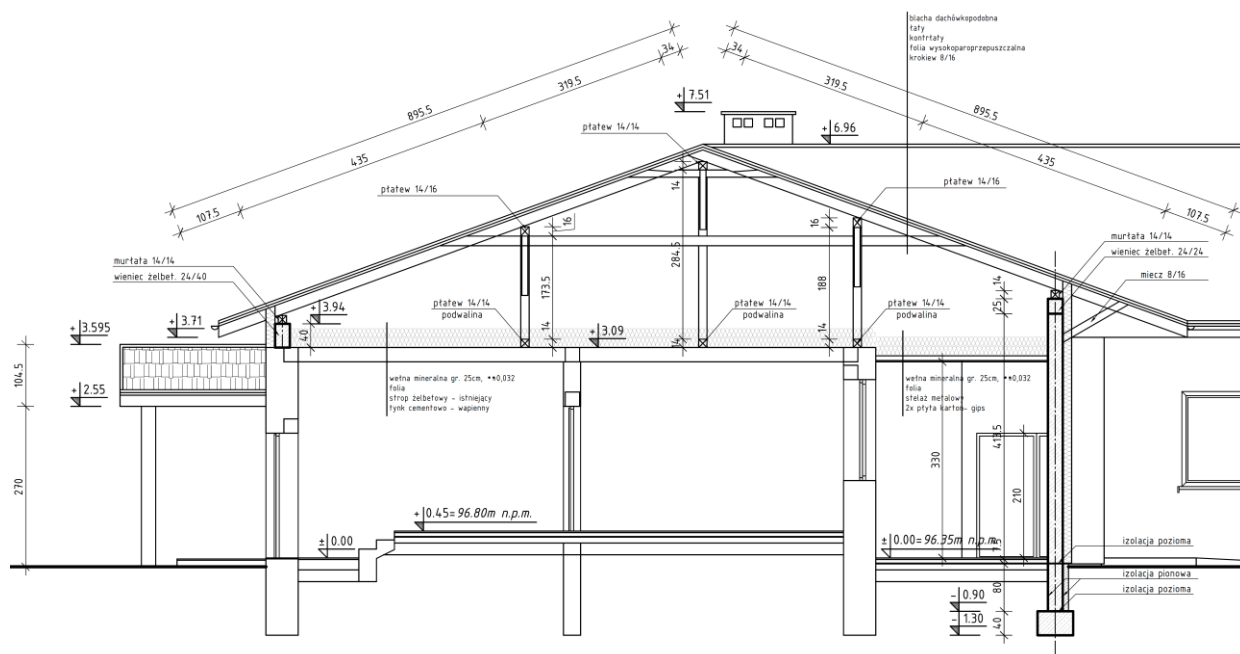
Widok zaplecza przy sali gimnastycznej
